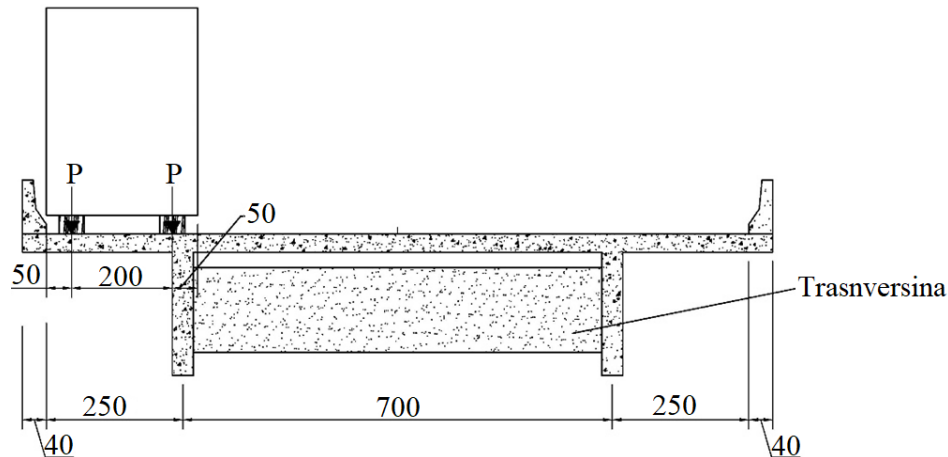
Vehículo de sección transversal tipo TB 450, para la situación de máxima tensión en la viga izquierda de la figura (dimensiones en centímetros) (Autor propio, 2019).
